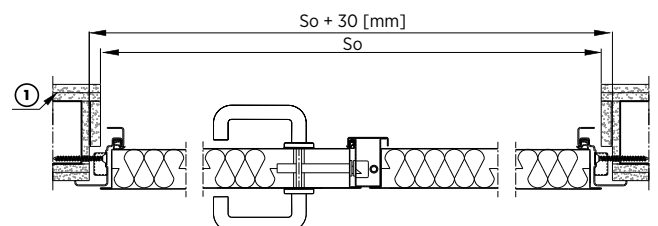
Montage mural d'un bloc-porte à deux battants avec bâti angulaire - coupe horizontale
